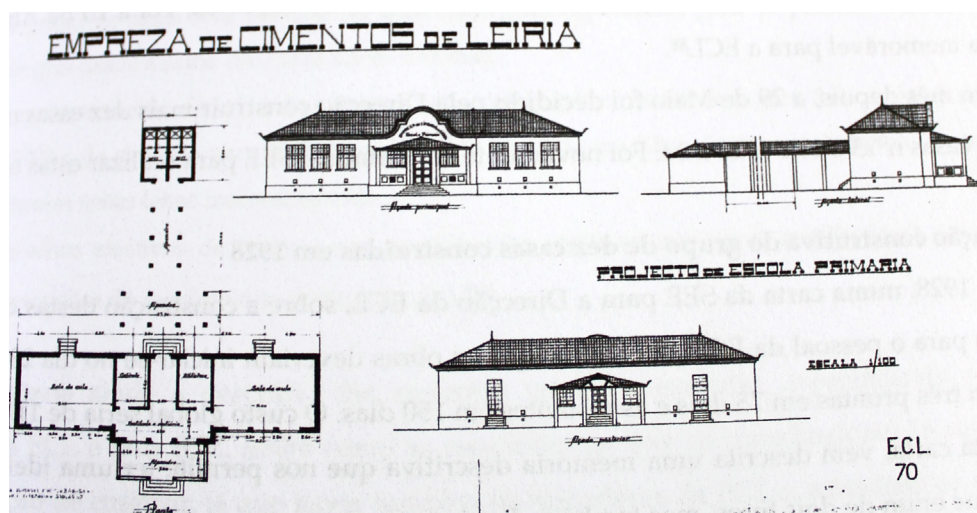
Planta e alçados da Escola Primária n.º1, s.d
